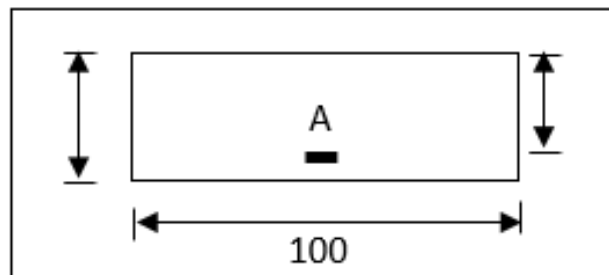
Section du calcul d'une dalle pleine en travée sens x-x
